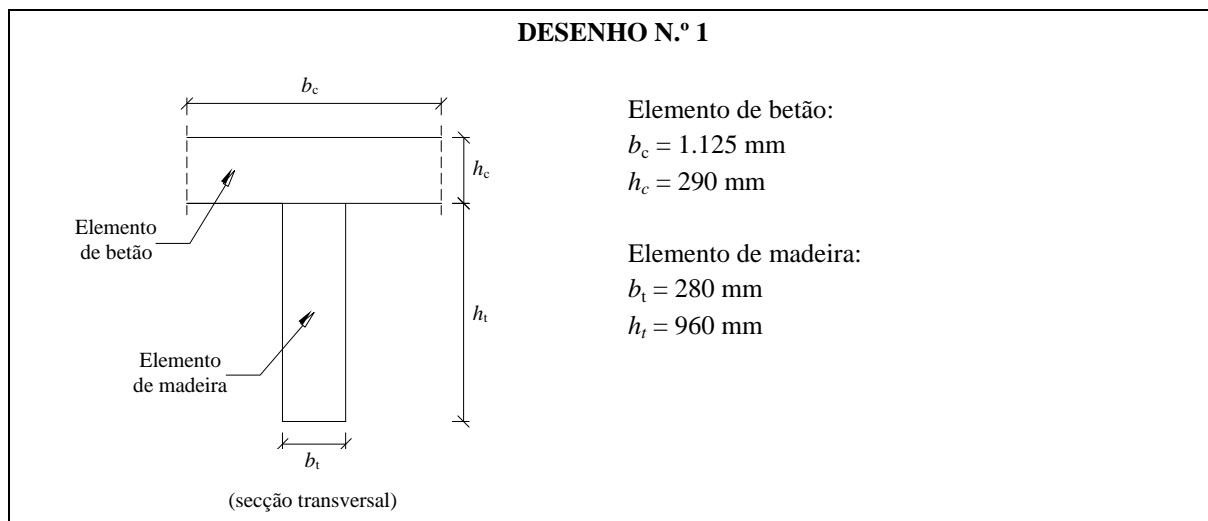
Pré-dimensionamento da secção transversal dos elementos de madeira e betão, solução-tipo I (caso particular).
